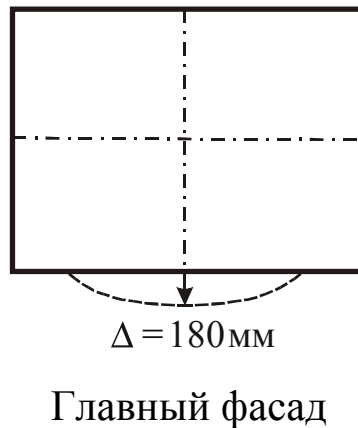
Схема деформирования жилого дома № 5 в квартале 30
